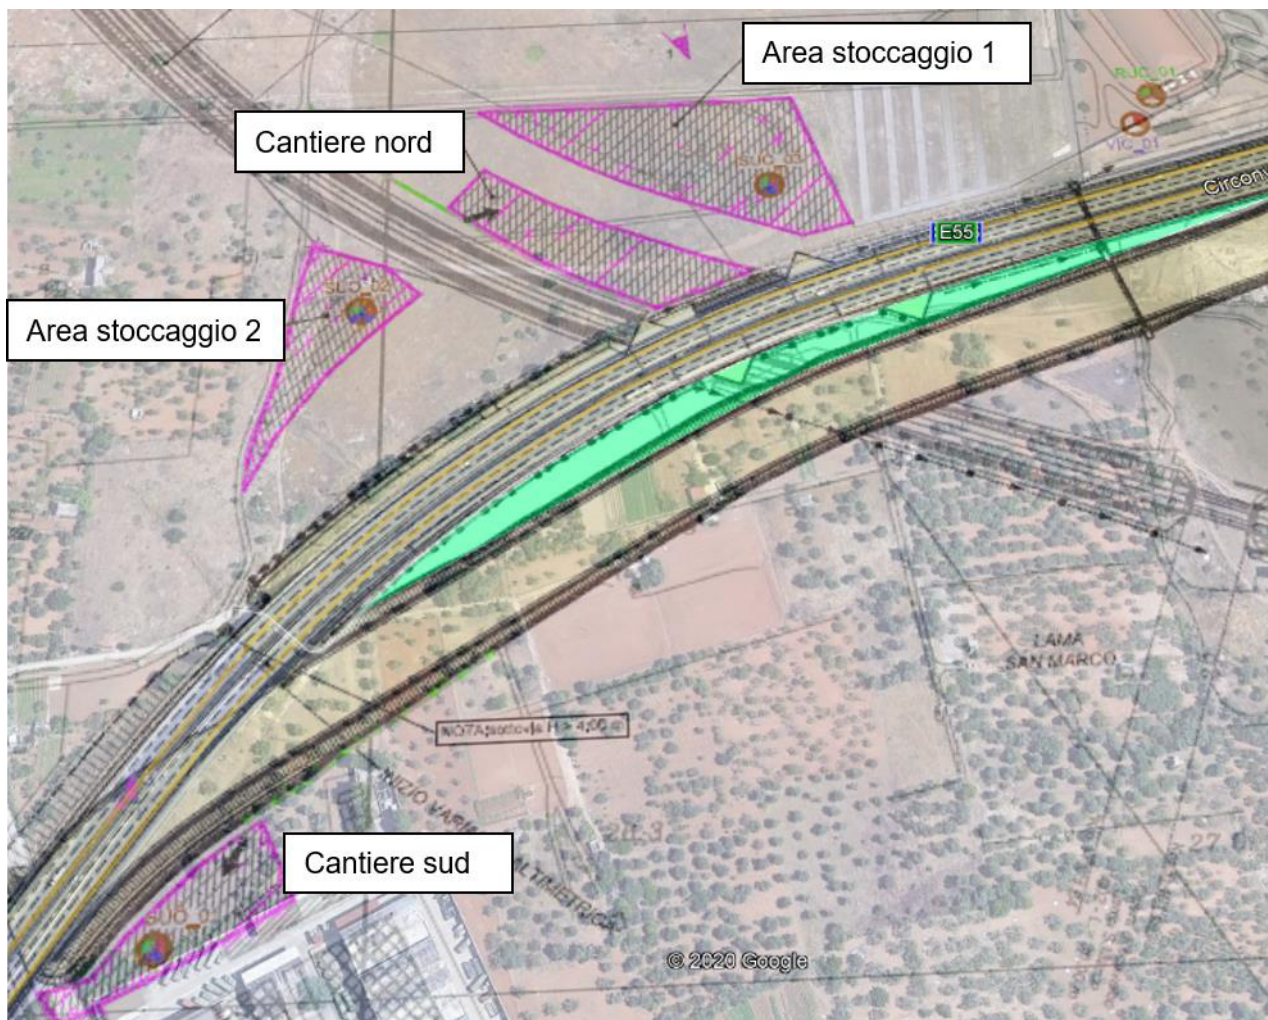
Localizzazione delle aree di cantiere e di stoccaggio
